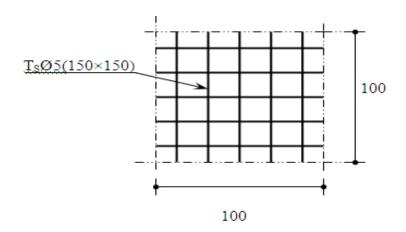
Schéma de ferraillage de la dalle de compression.
